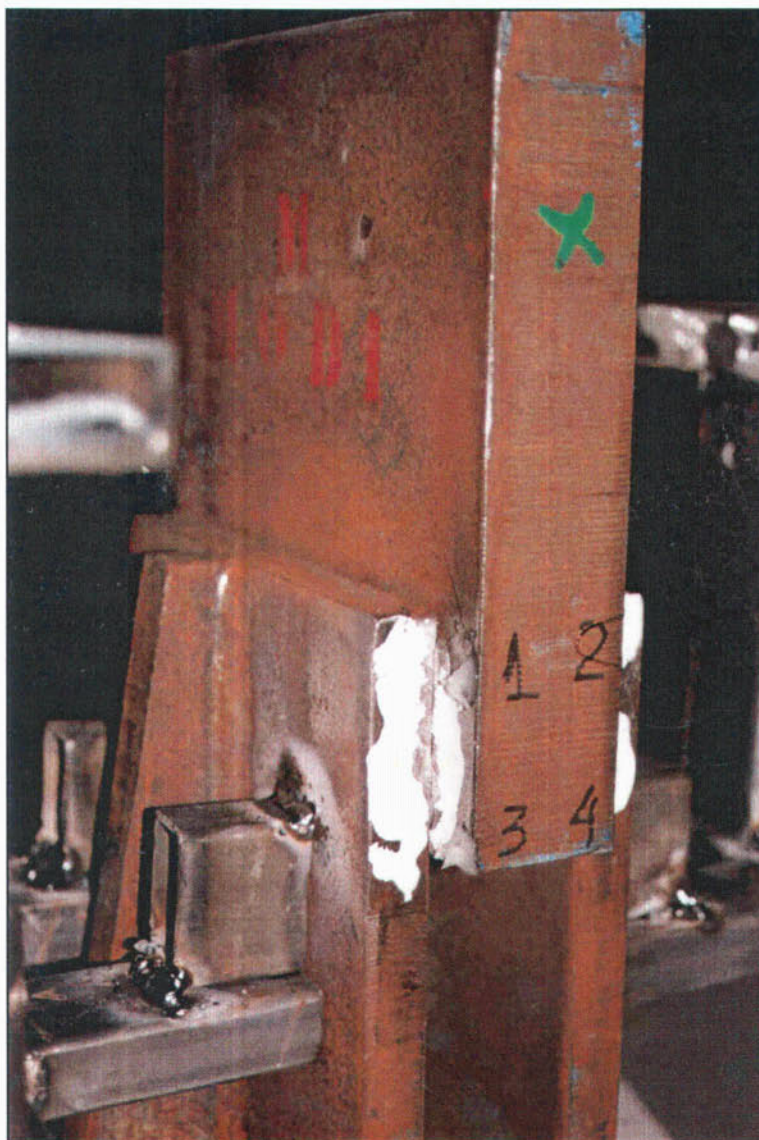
Probeta 1M después del ensayo. Se observa la rotura por el plano de garganta en la soldadura 1-3. La cal se encuentra desprendida en dicha zona de rotura.
